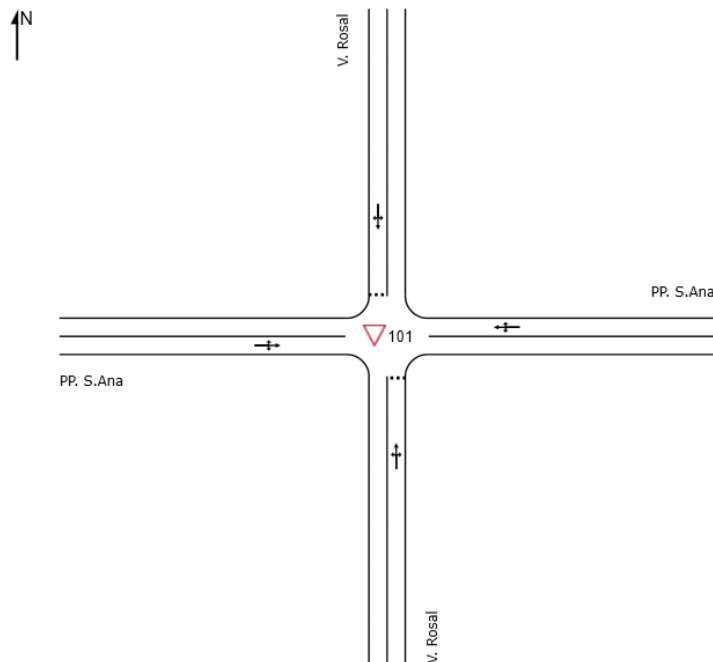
Esquema de la intersección del Plan parcial El Rosal.
